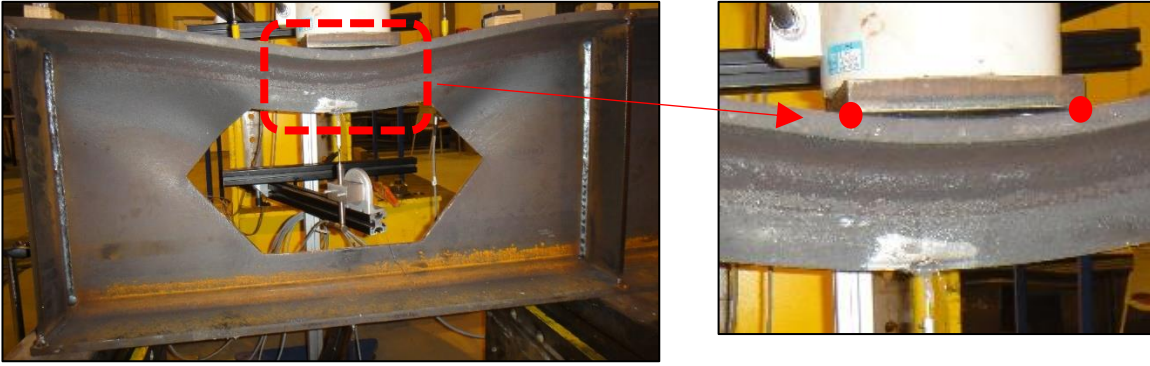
Observation des zones de contact entre plaque de chargement et poutre
